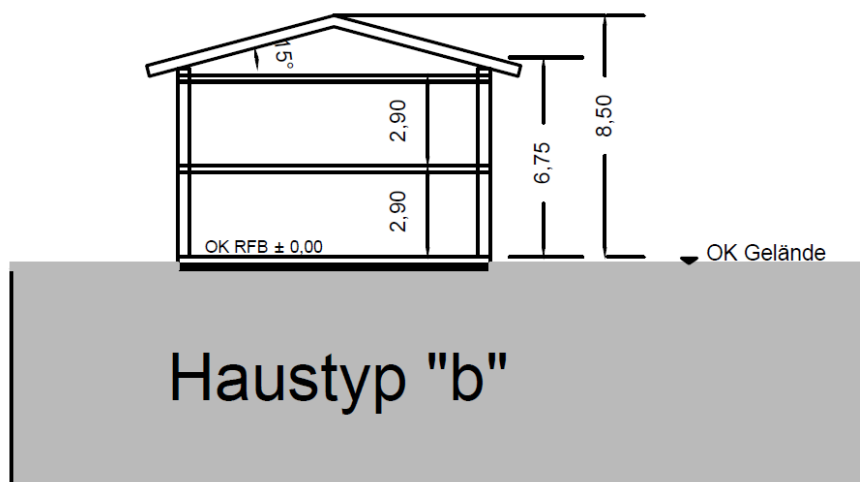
Systemschnitt Haustyp „b“ zwei Vollgeschosse
